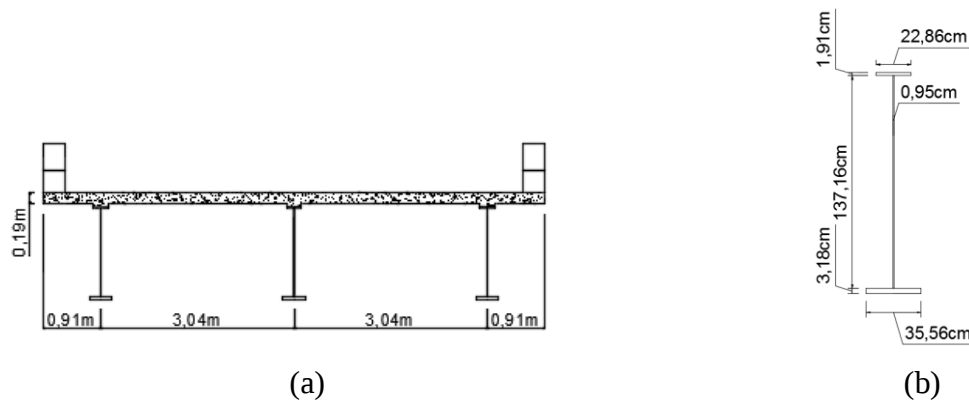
(a) Seção transversal da ponte; (b) Detalhe da seção transversal da viga
